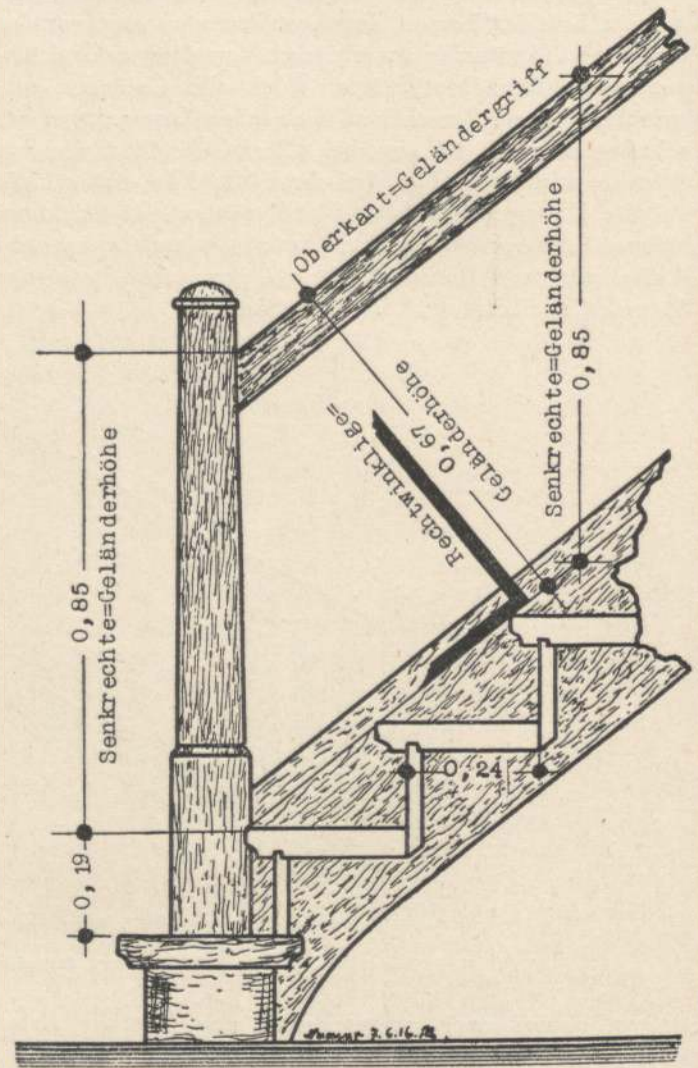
Je steiler die Geländerneigung desto kleiner wird die rechtwinklige Geländerhöhe.
